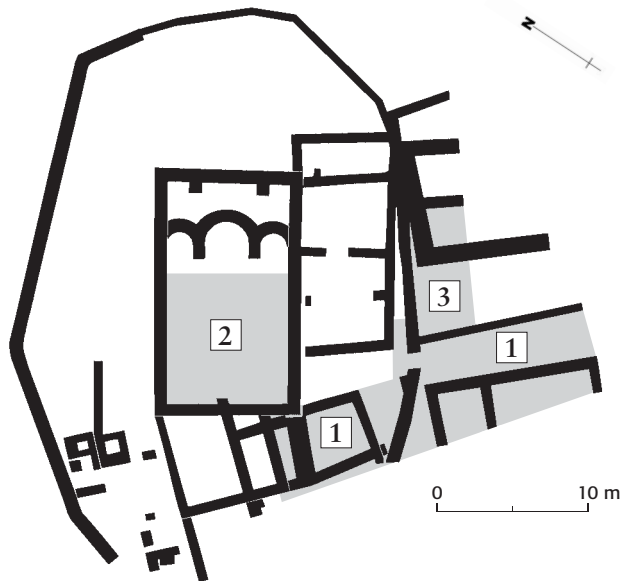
Tumejl/Tomils, Sogn Murezi. Schematischer Grundriss mit den Arbeitsplätzen.
